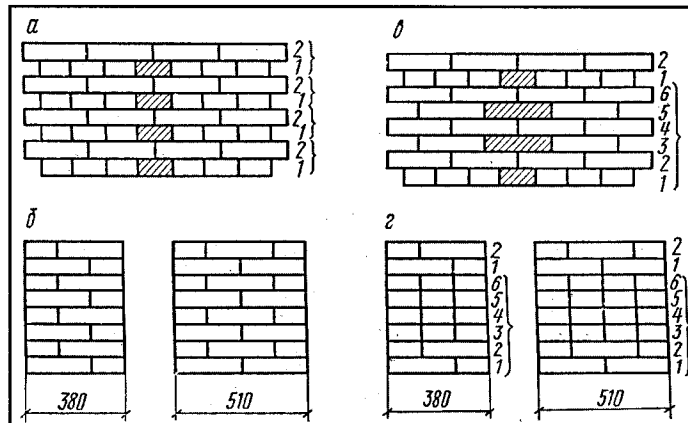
Системи кладки: а - фасад дворядної системи кладки; б - перерізи; в - фасад шестирядної системи кладки; г - перерізи.
